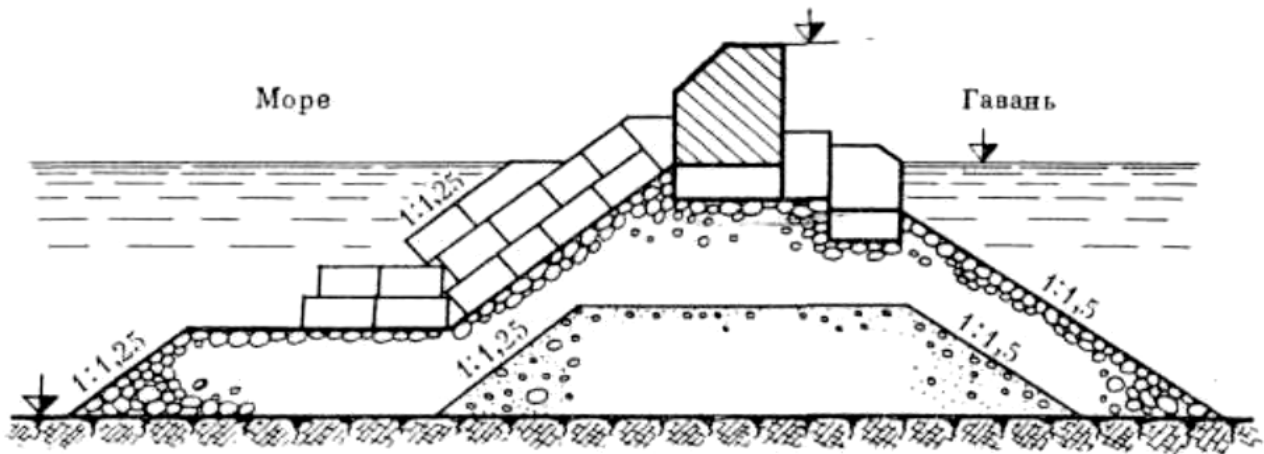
Розріз кам'яно-накидного спорудження з покриттям укосу кладкою з бетонних плит
